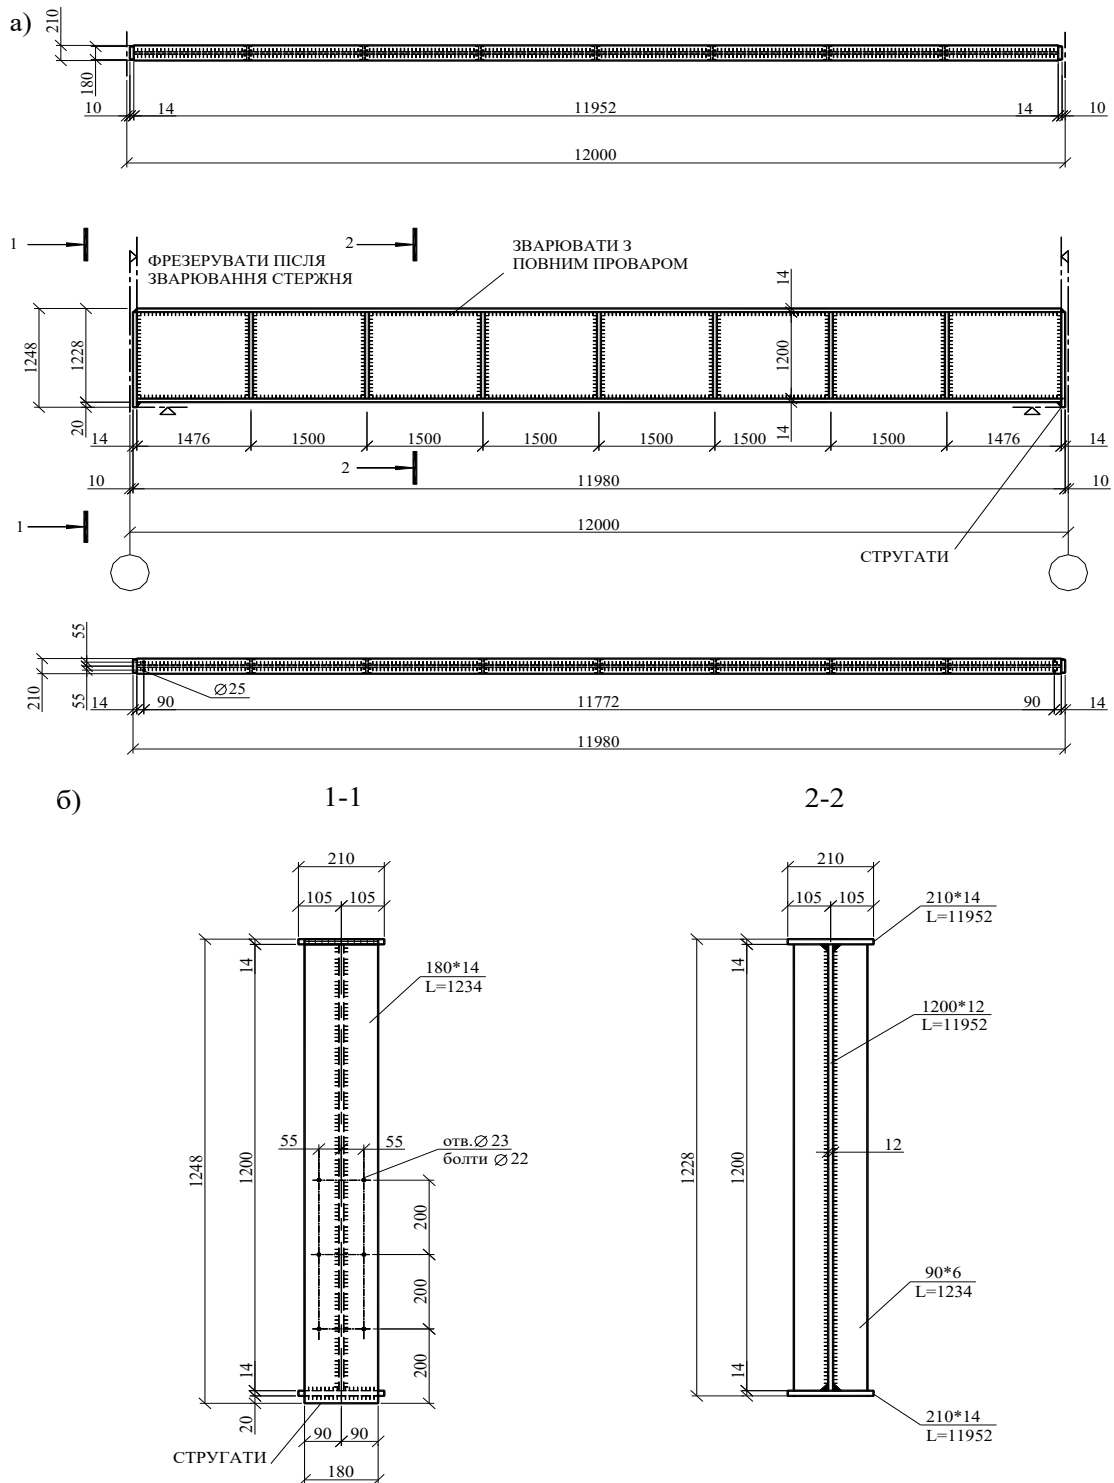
Креслення підкранової балки: а – загальний вид, плани поясів; б – перерізи
